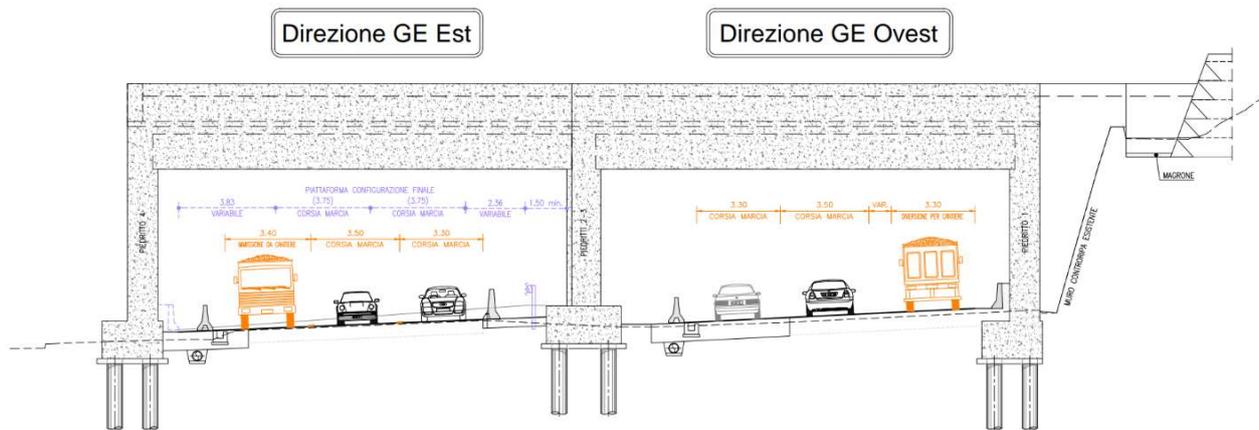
Galleria artificiale Torbella – Sezione trasversale della carpenteria generale del progetto di modifica
